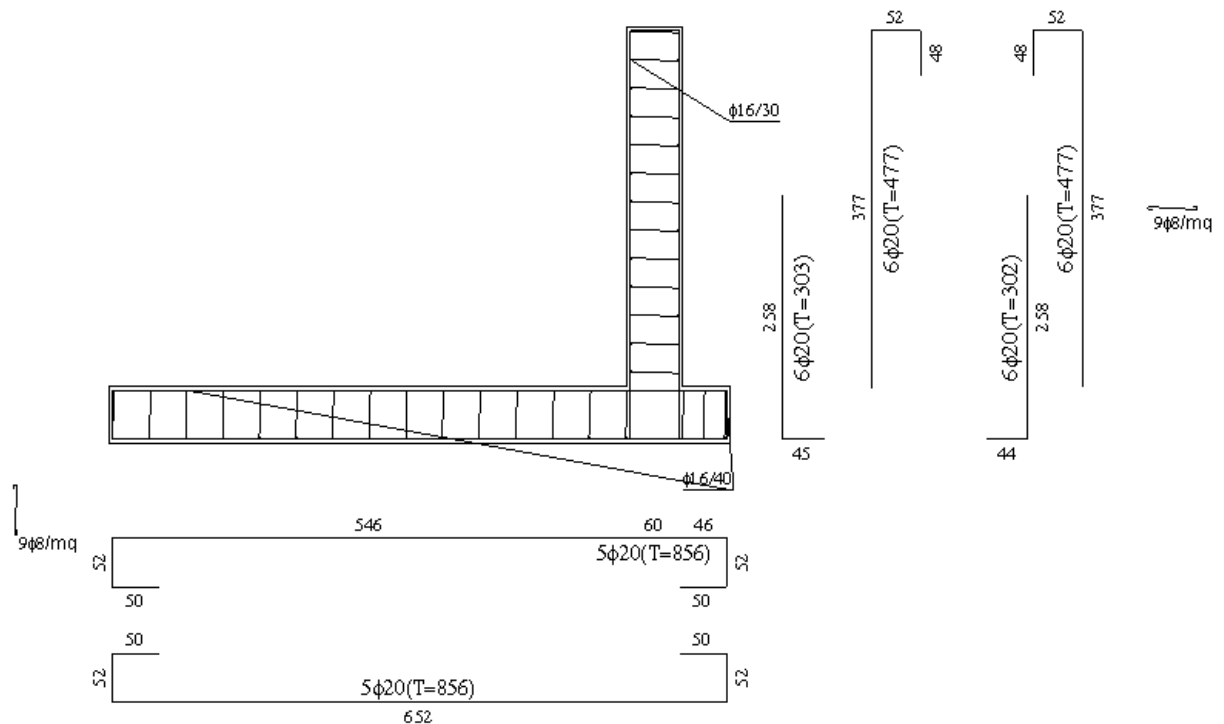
Schema delle armature, sezione trasversale dell’opera di derivazione
